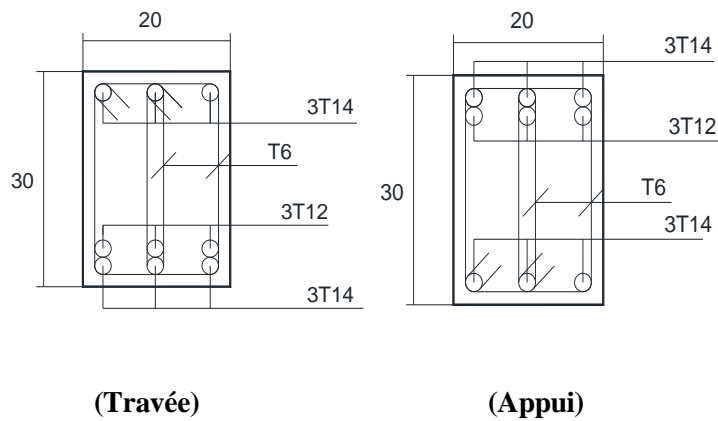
Ferrailage d'une poutre secondaire 20x30cm (bâtiment R+10)
